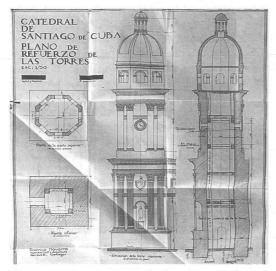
Plano de refuerzo de las torres mediante armazón en hormigón armado proyectado por Federico Navarro en el 1932 (VIVAC 1932)
